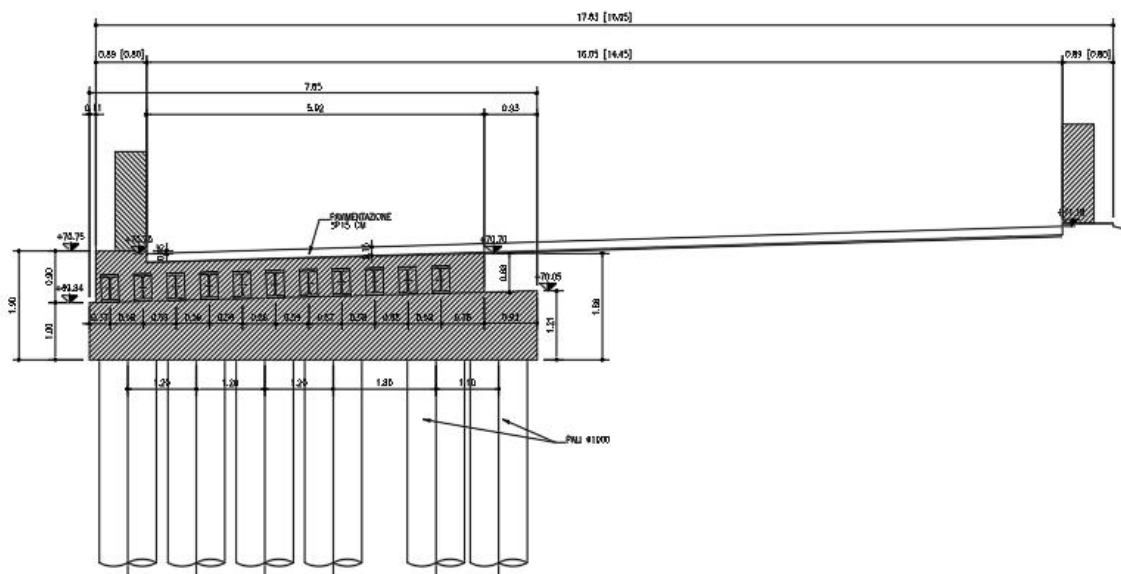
Sezione trasversale dell'impalcato – Lato Milano
